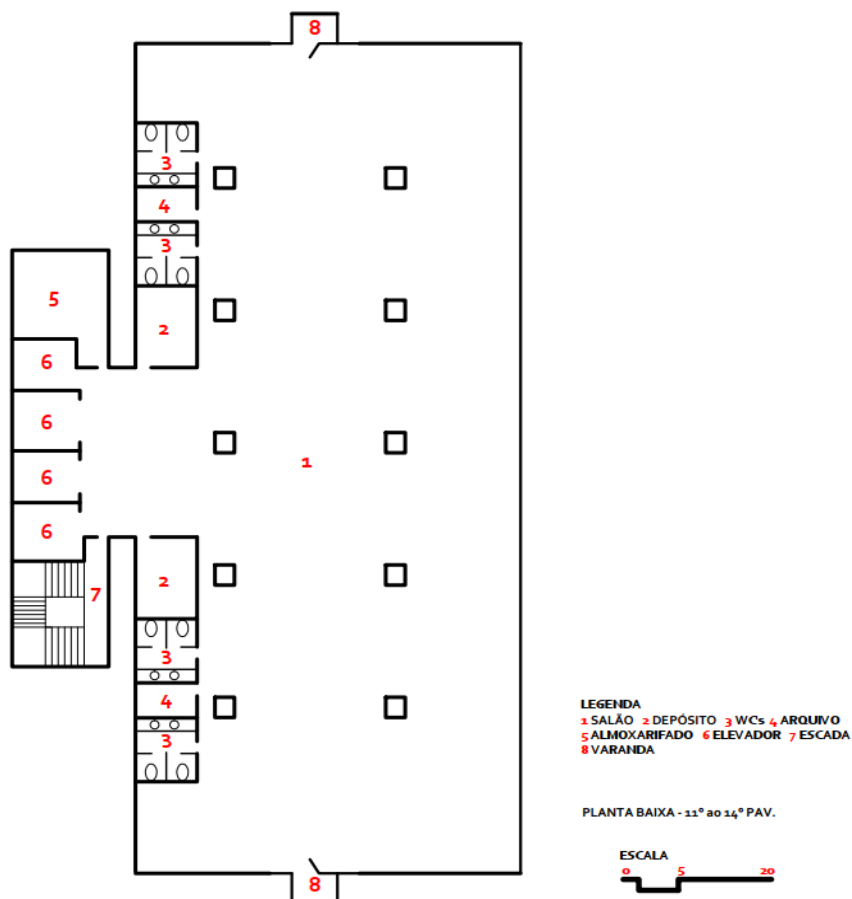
Planta Baixa – 11º ao 14º Pavimento. Fonte: Redesenho feito pelo autor, 2020.
